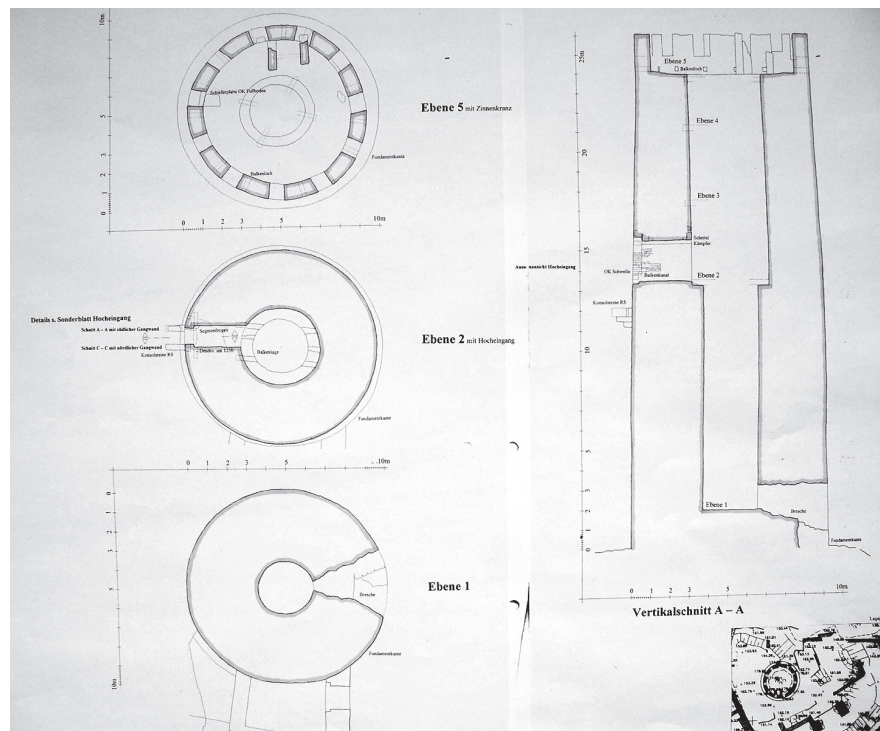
Burgruine Fürstenberg bei Rheindiebach, Bergfried, Grundrisse und Schnitt (Zeichnung: LAD).
